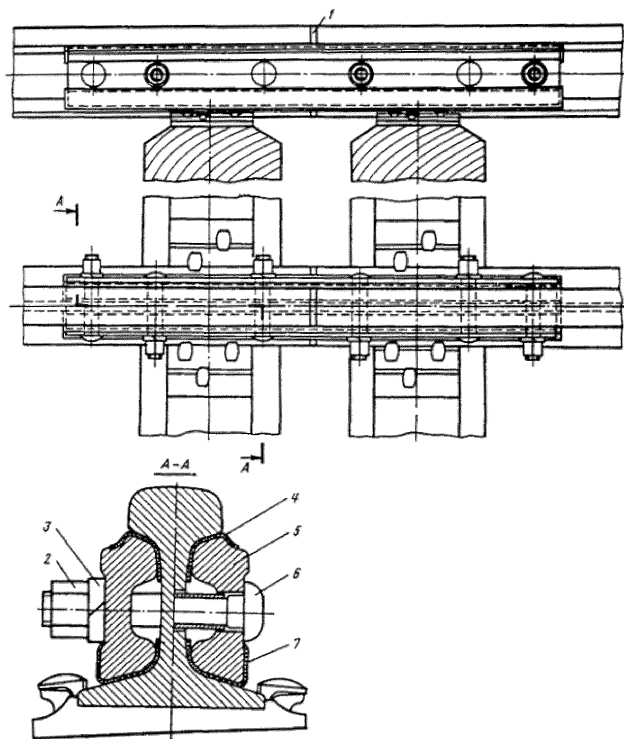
Стык, изолирующий рельсов типа Р65 с комбинированными (металлокомпозитными) накладками
